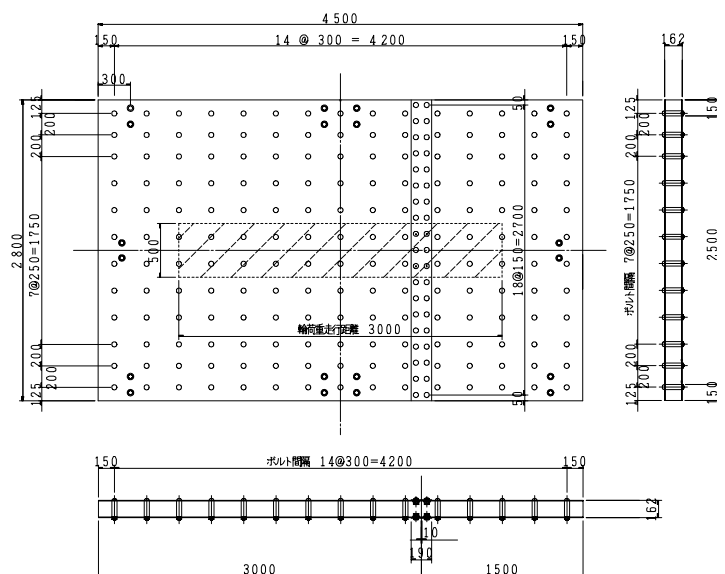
サンドイッチ床版供試体の形状・寸法（単位：mm）
